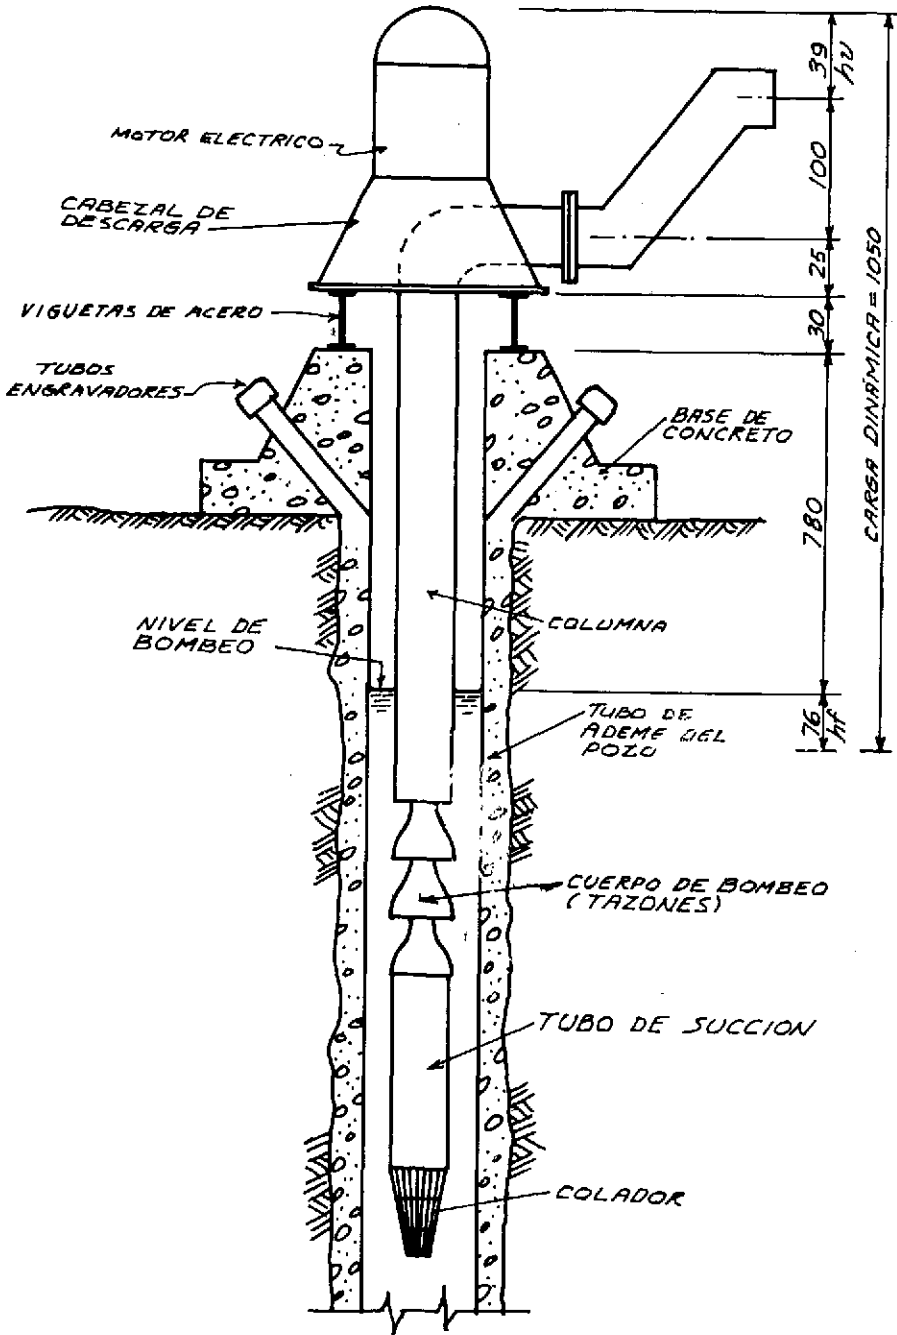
Disposición del equipo de bombeo ya instalado en el pozo.
